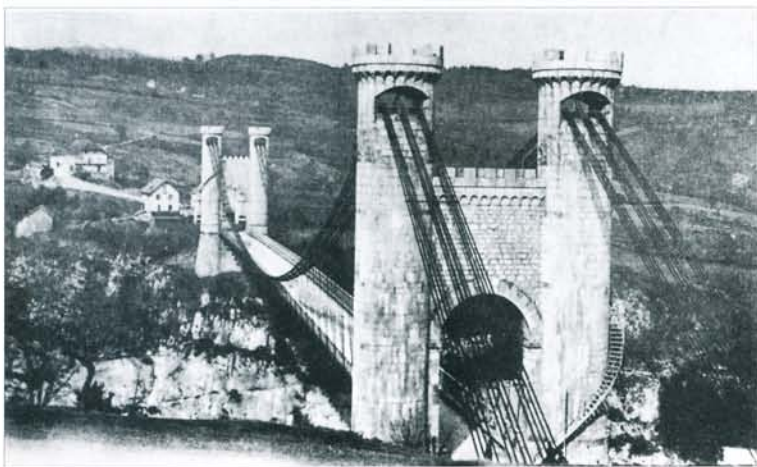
Le pont de La Caille (Savoie) construit en 1839
